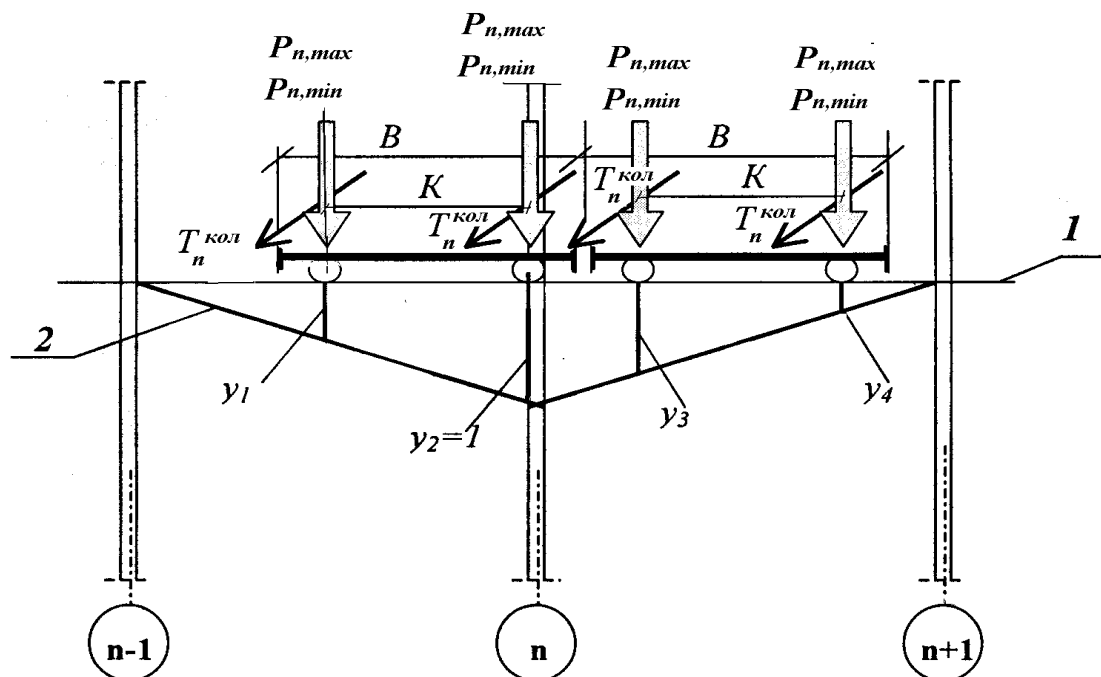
Схема расположения двух сближенных мостовых кранов на подкрановой балке для определения крановых нагрузок на поперечную раму здания:
